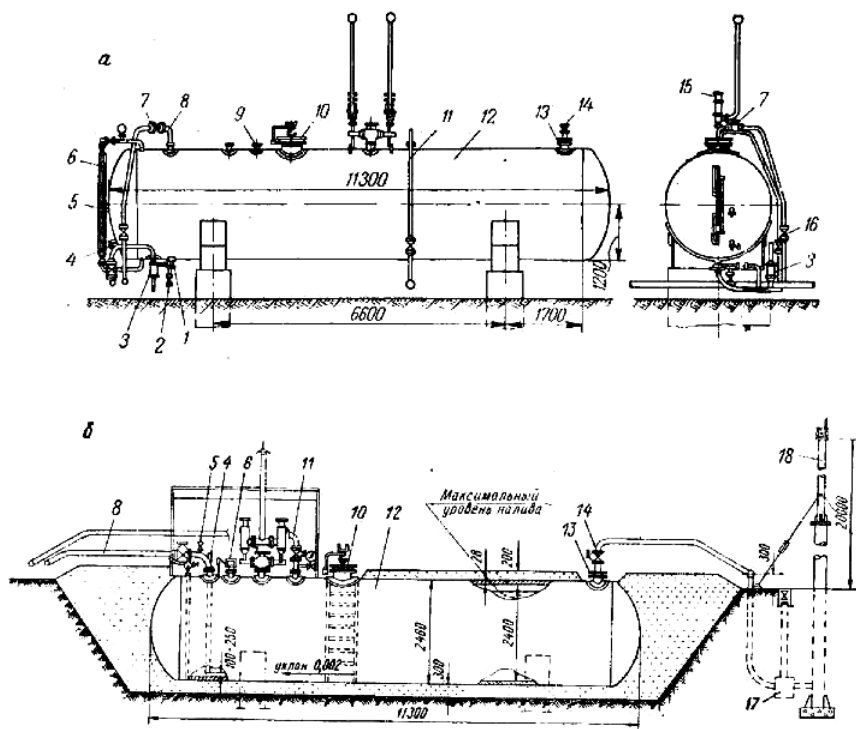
Конструкция и схема обвязки наземного (а) и подземного (б) цилиндрических резервуаров:
